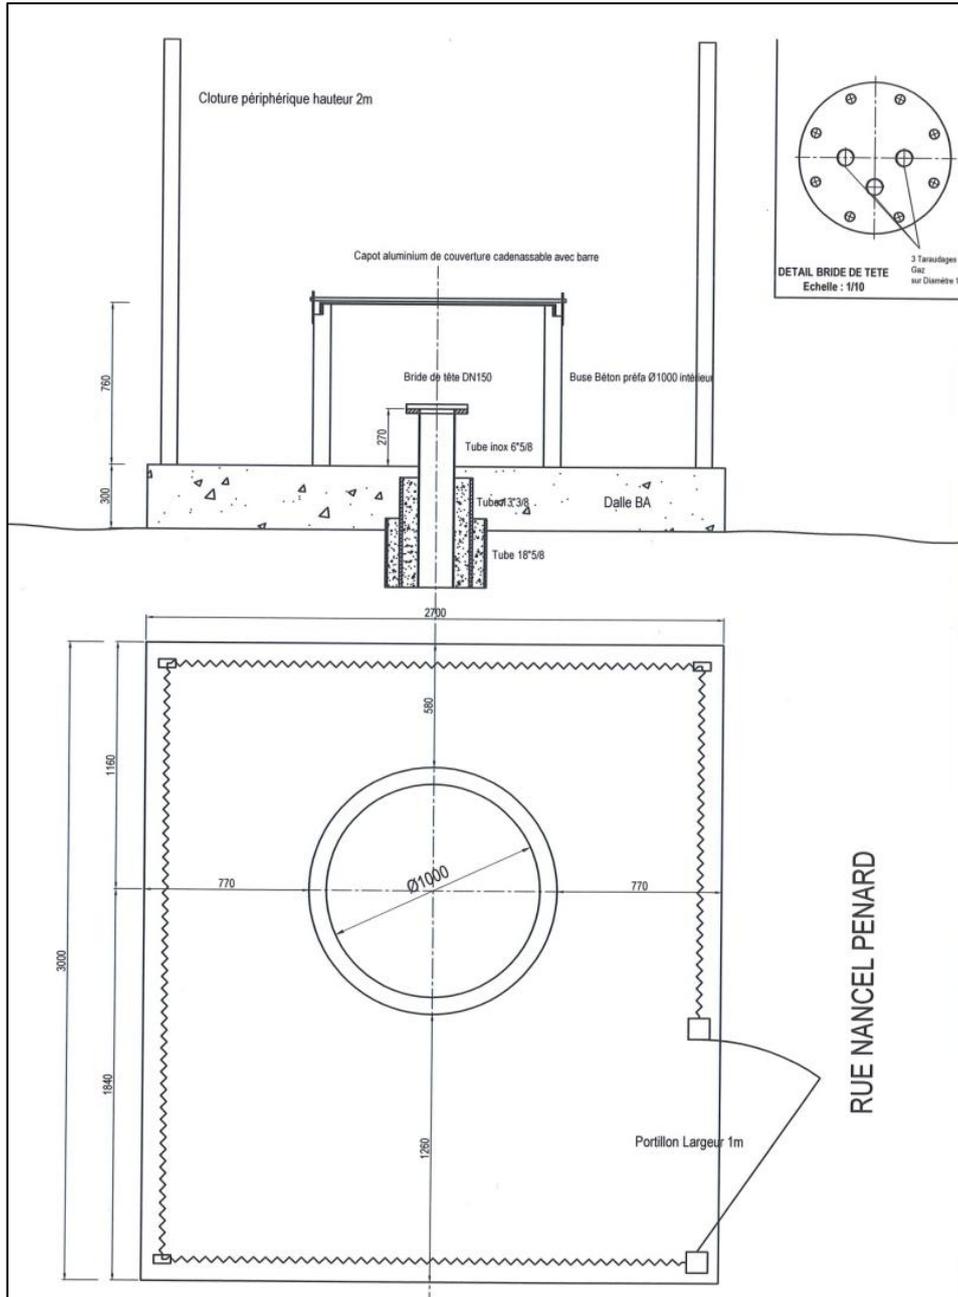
Coupe et plan des aménagements réalisés autour du forage
